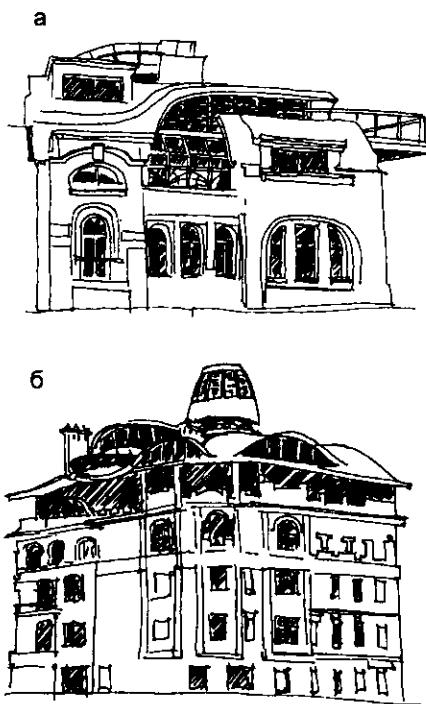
Реконструированные здания архитектора А.Асадова в Москве
